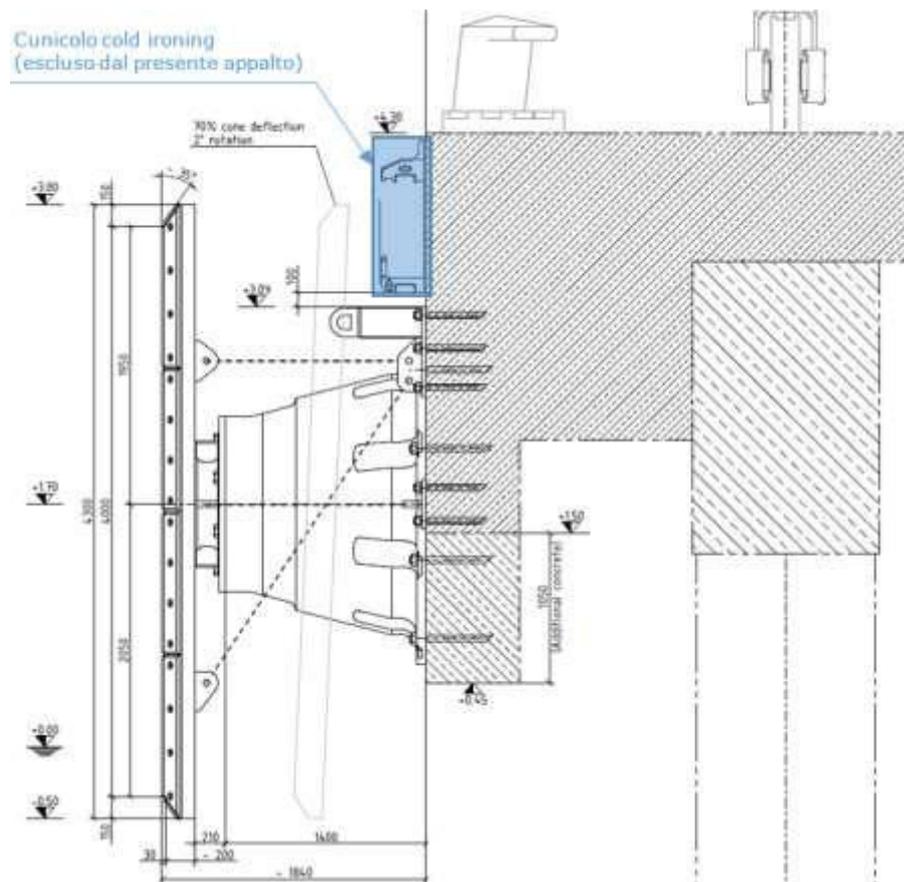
Sezione tipica della banchina con in evidenza la posizione dei parabordi
